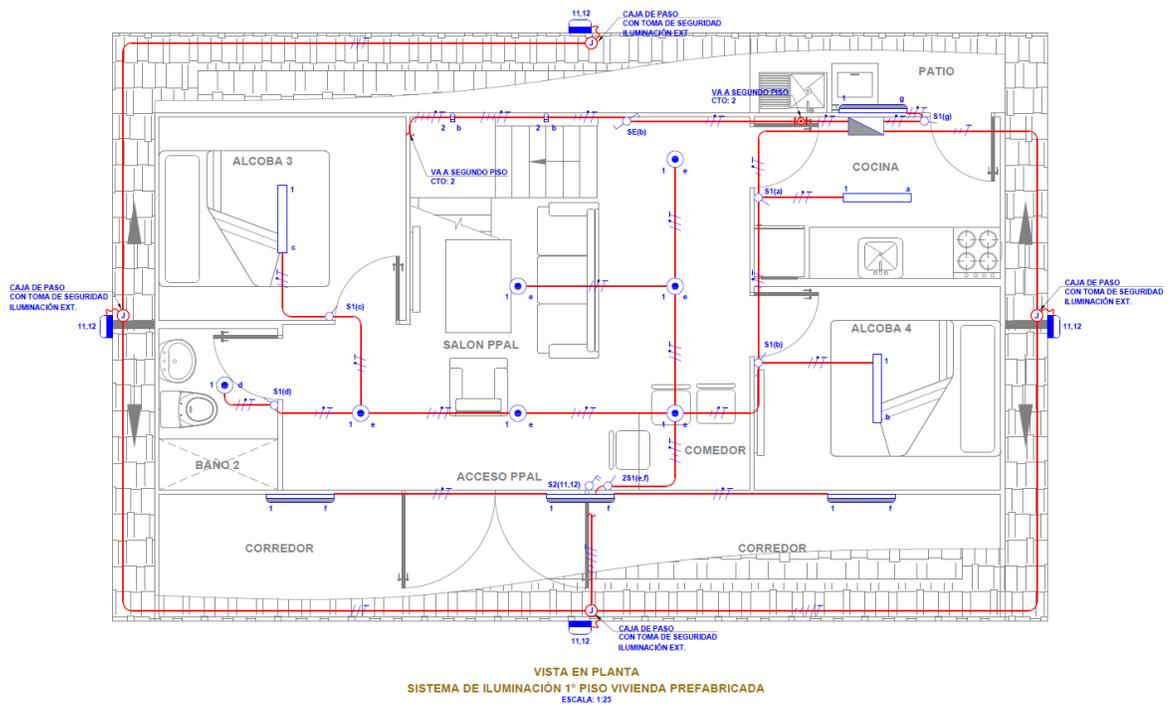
vista en planta sistema de iluminación piso 1 vivienda prefabricada (los autores).
